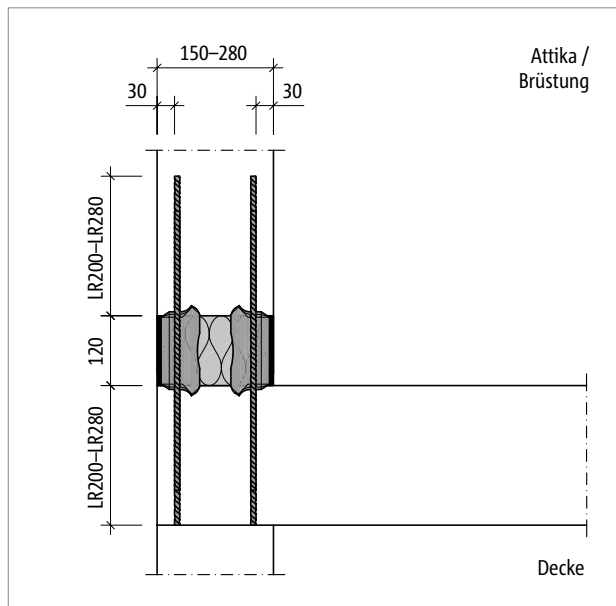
Schöck Isokorb® CXT Typ A-MM1-REI30: Produktschnitt
